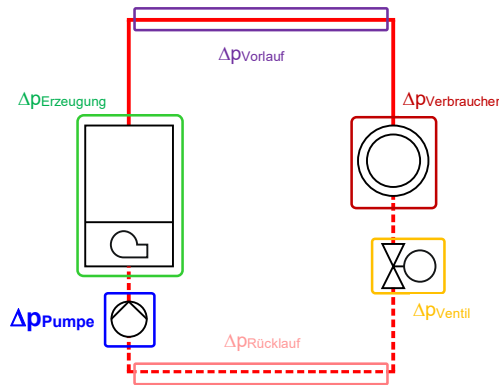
HLK-Anlage mit hydraulischen Widerständen
